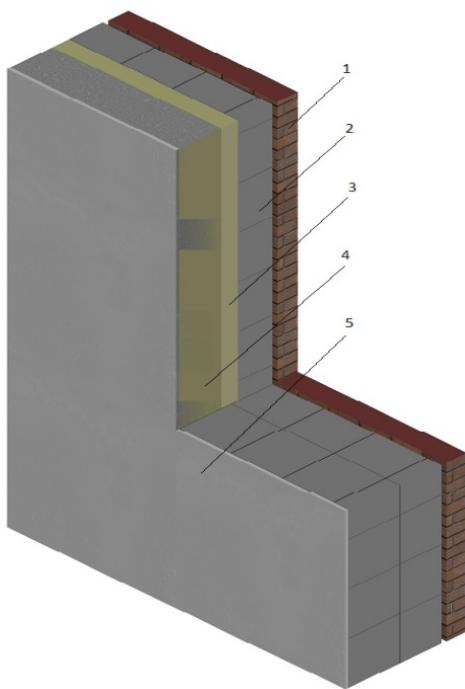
Слой облицовочного керамического пустотелого кирпича 1НФ 120 мм – 1; слой воздушной прослойки до 30 мм; слой кладки из газобетона 200 мм – 2; слой минераловатного утеплителя 100 мм – 3; Ж/Б пилон 250 мм – 4; штукатурный слой – 5
